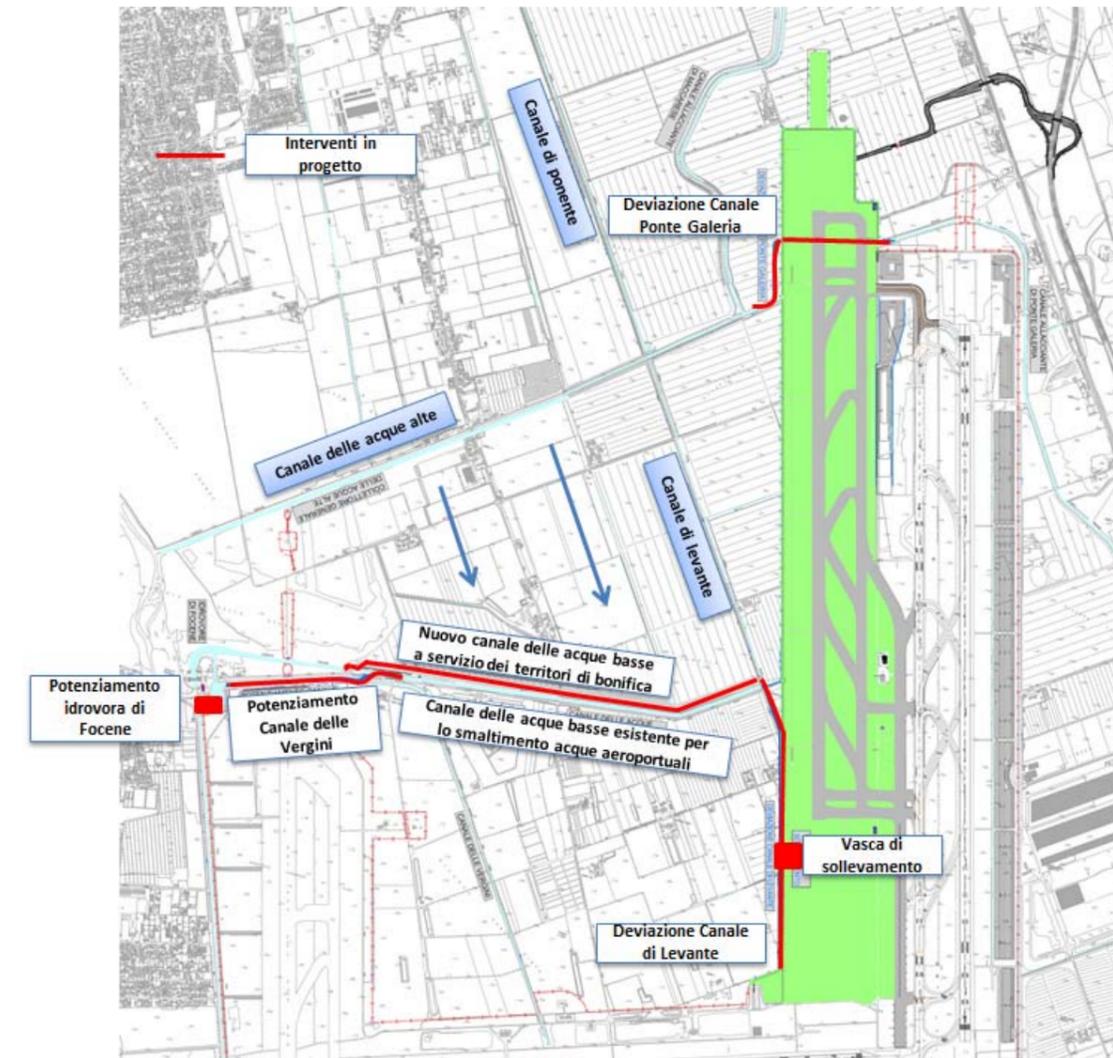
Sistema di drenaggio di progetto Prima fase di sviluppo Pista 4, interventi previsti
